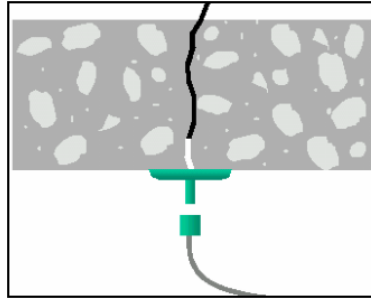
Injeção de epóxi em trincas e fissuras com abertura superior a 0,3 mm (MACHADO, 2006)
